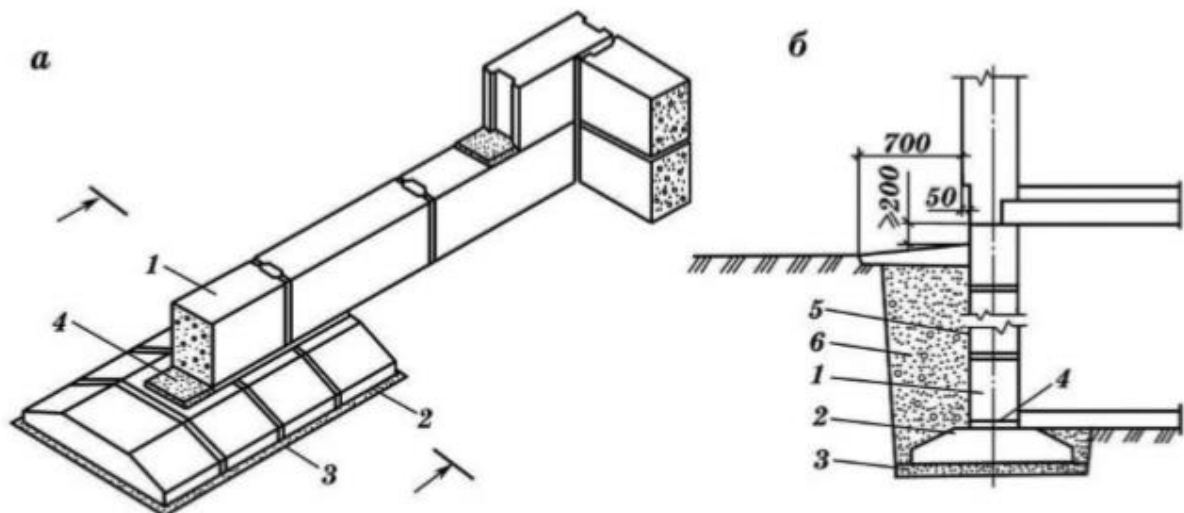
Схема стрічкового фундаменту зі збірних бетонних блоків
